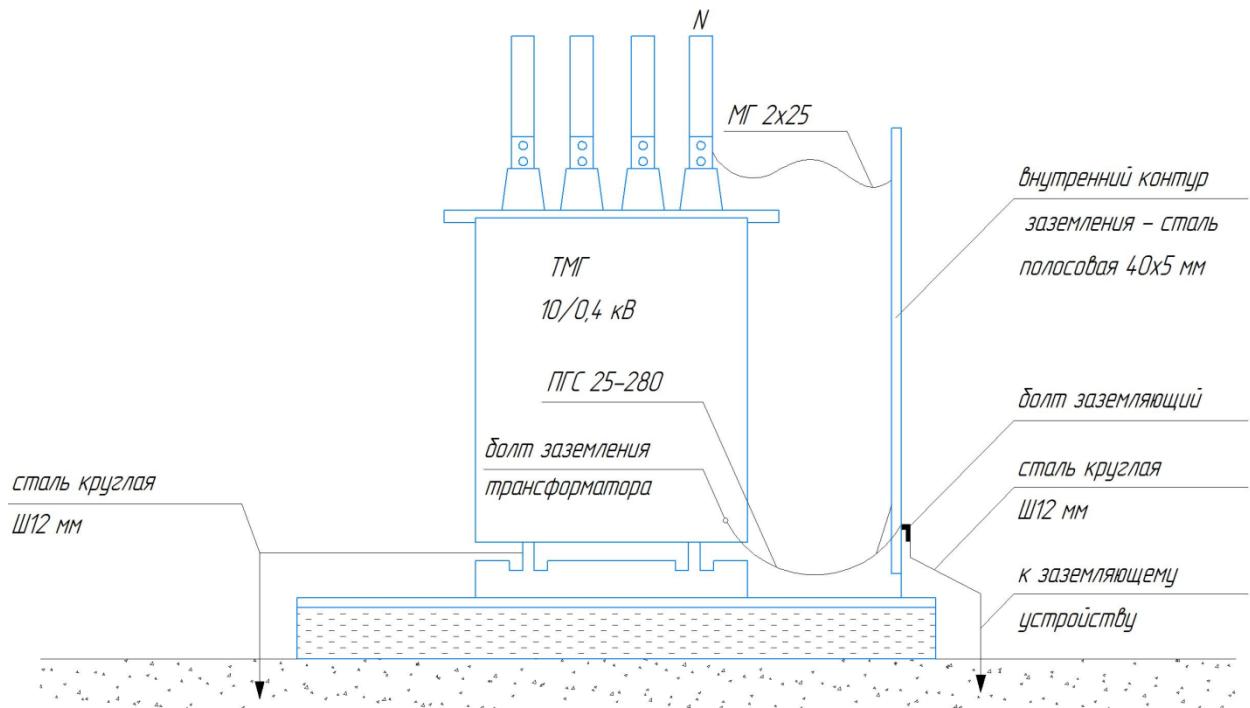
Предлагаемая установка заземления на корпус трансформатора
